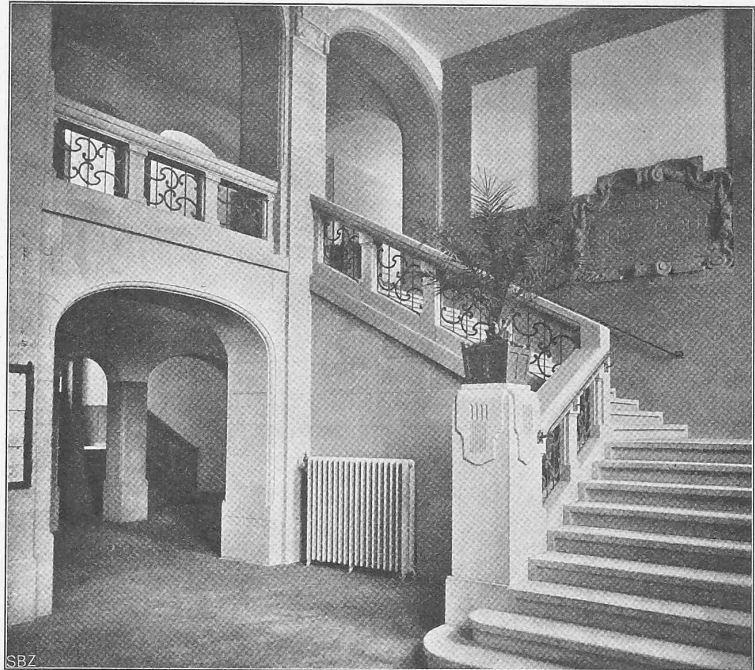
Blick aus der Erdgeschosshalle nach dem Treppenhaus.
